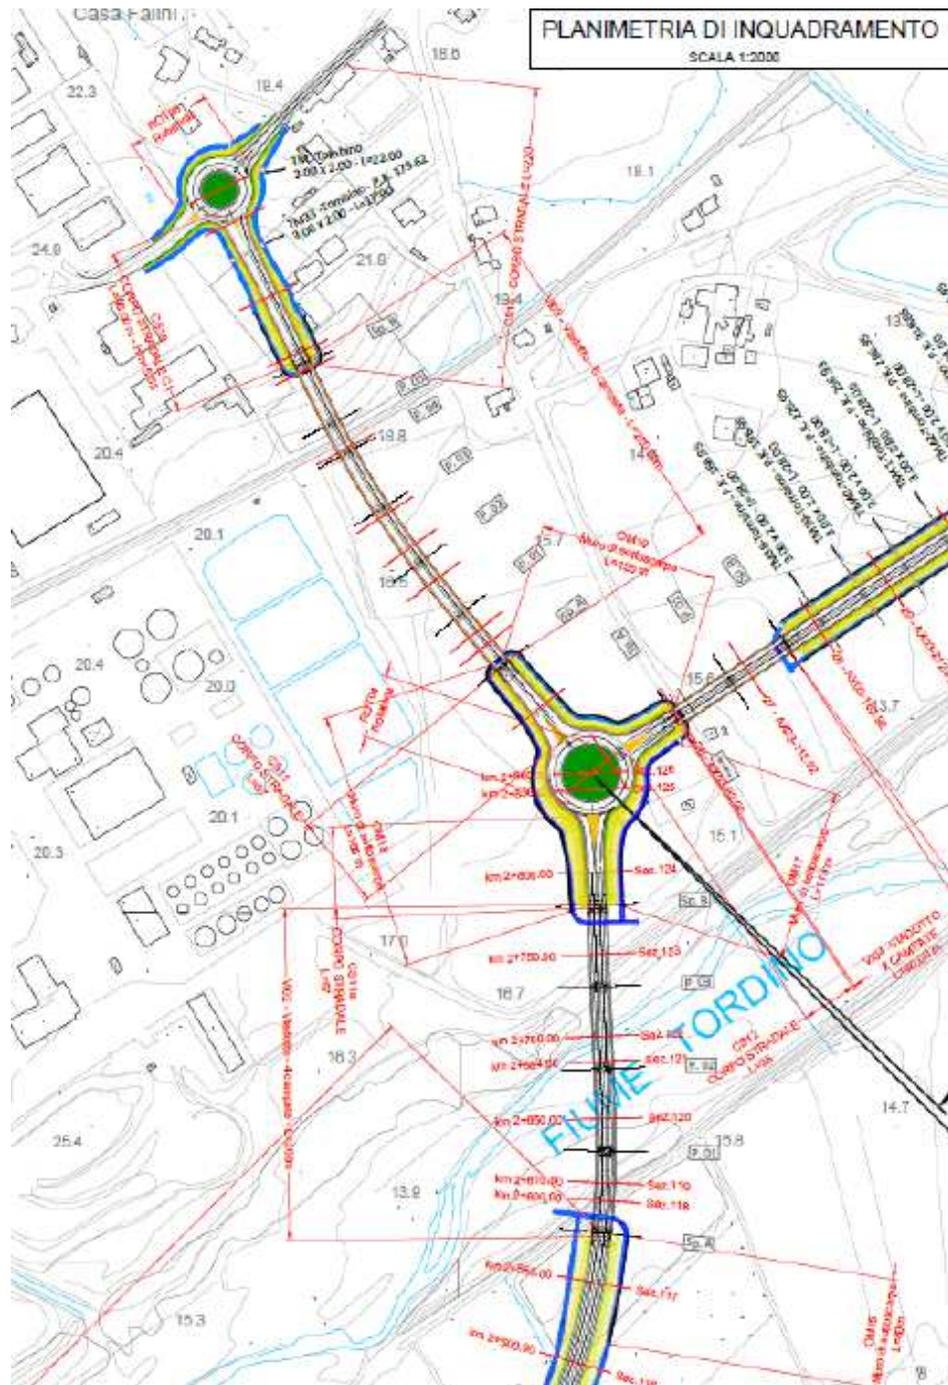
Planimetria progetto stradale e Viadotto su ferrovia Soluzione 2
